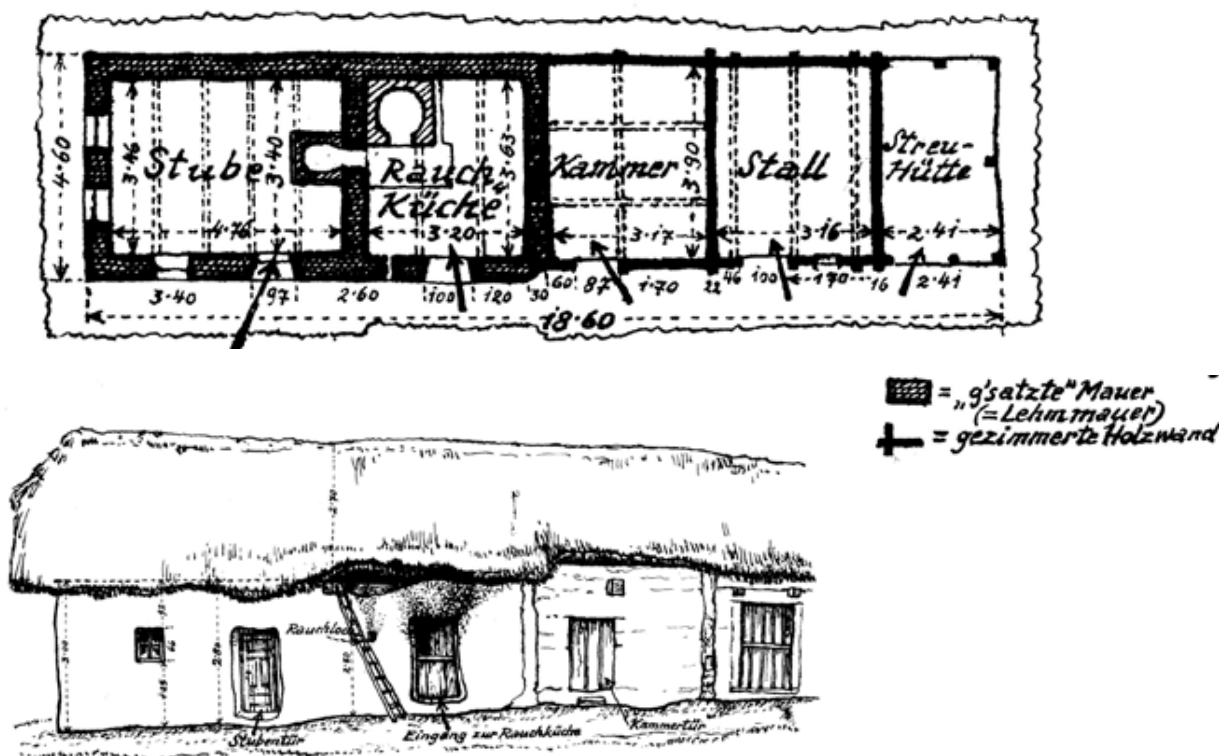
| Grundriss und Ansicht des Bauernhauses aus Kroatisch-Ehrendorf: Der durch das Heizen oder Backen entstandene Rauch zieht über die (halb)offene Tür oder das Rauchloch ab, weswegen die äußere Fassade über der Tür stets Rußablagerungen aufwies.
